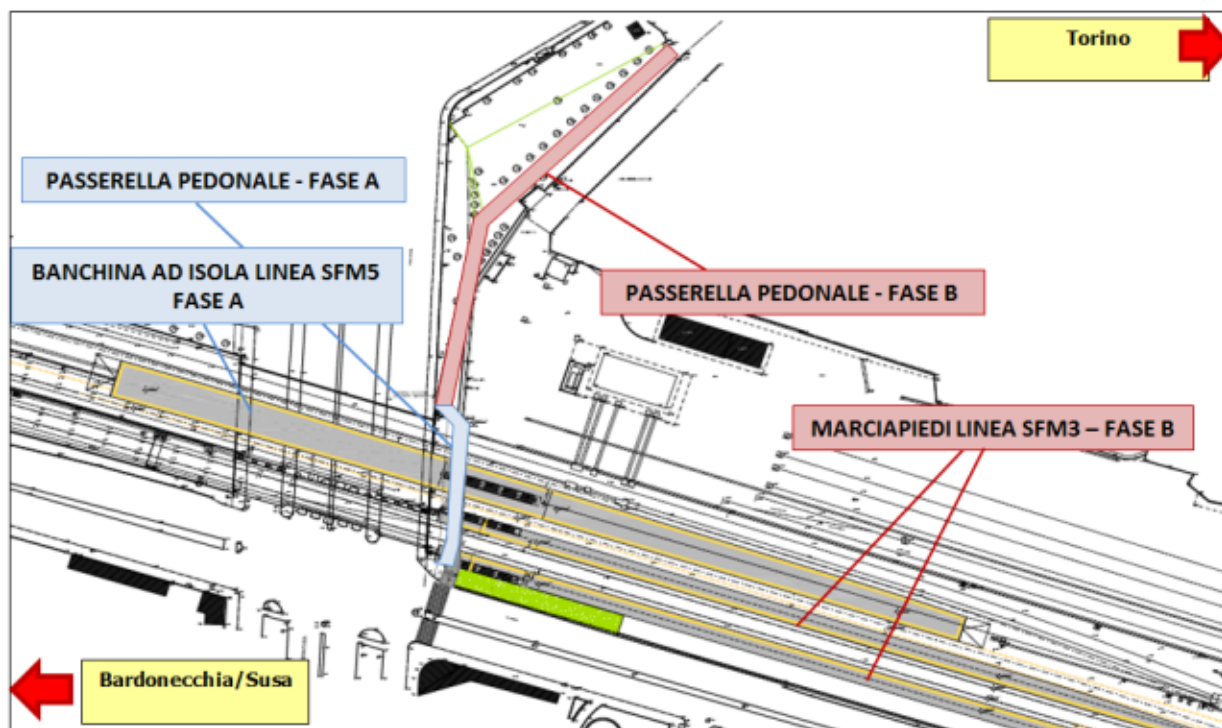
Individuazione degli interventi da realizzare in FASE A e FASE B
